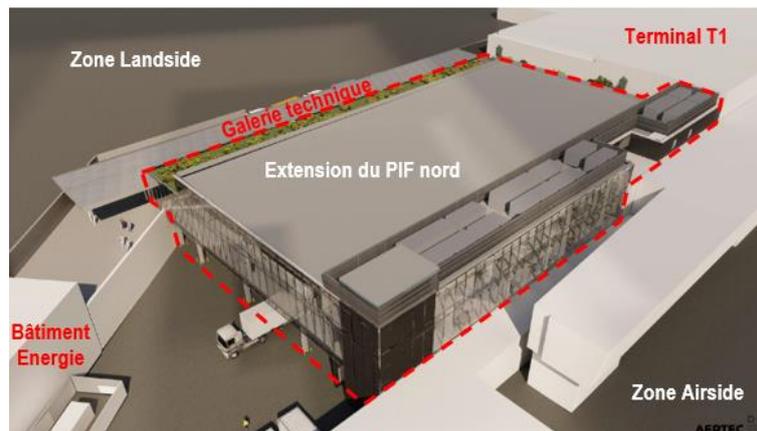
Insertion de l'extension du PIF Nord dans l'environnement construit existant (ARIES sur fond BAG-AERTEC, 2024)
